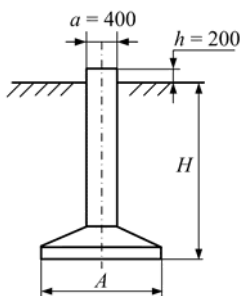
Типовой железобетонный фундамент (грибовидный подножник)
